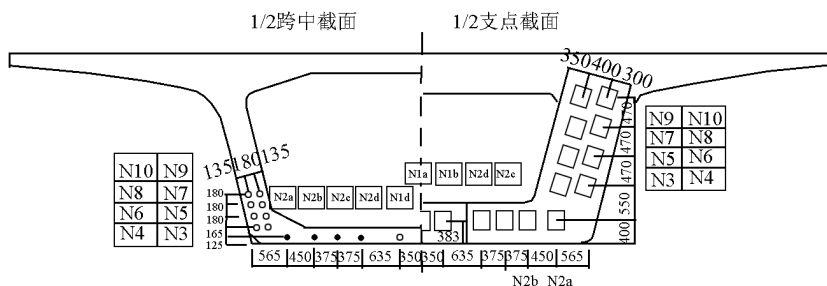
32 m 箱梁截面预应力筋布置图(单位:mm)
